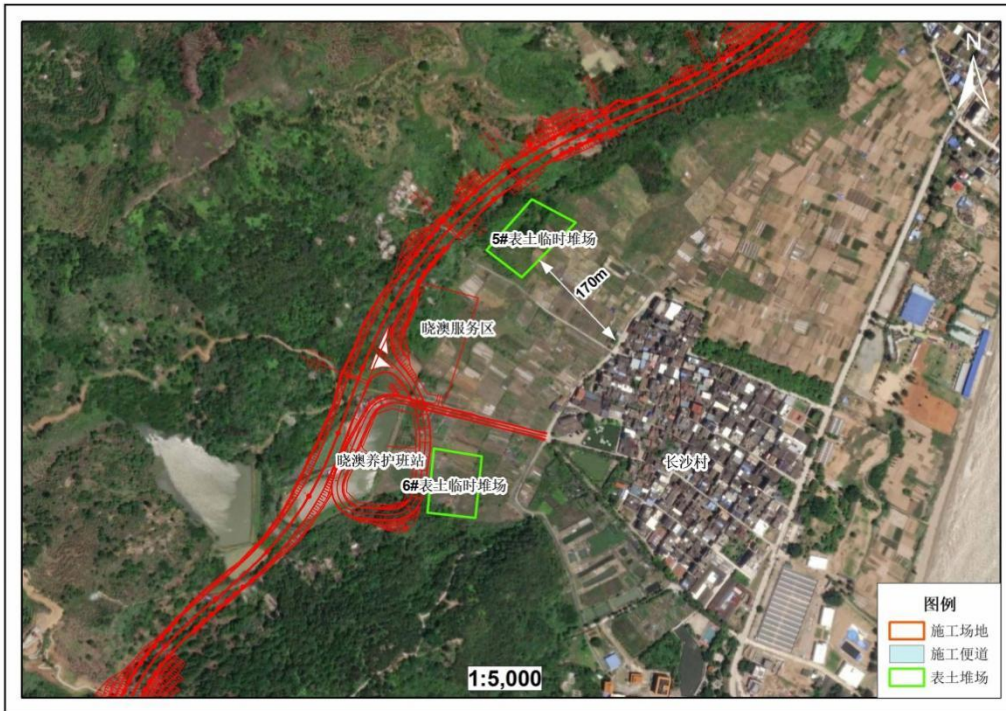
临时工程平面布置示意图（5#、6#表土堆场）
